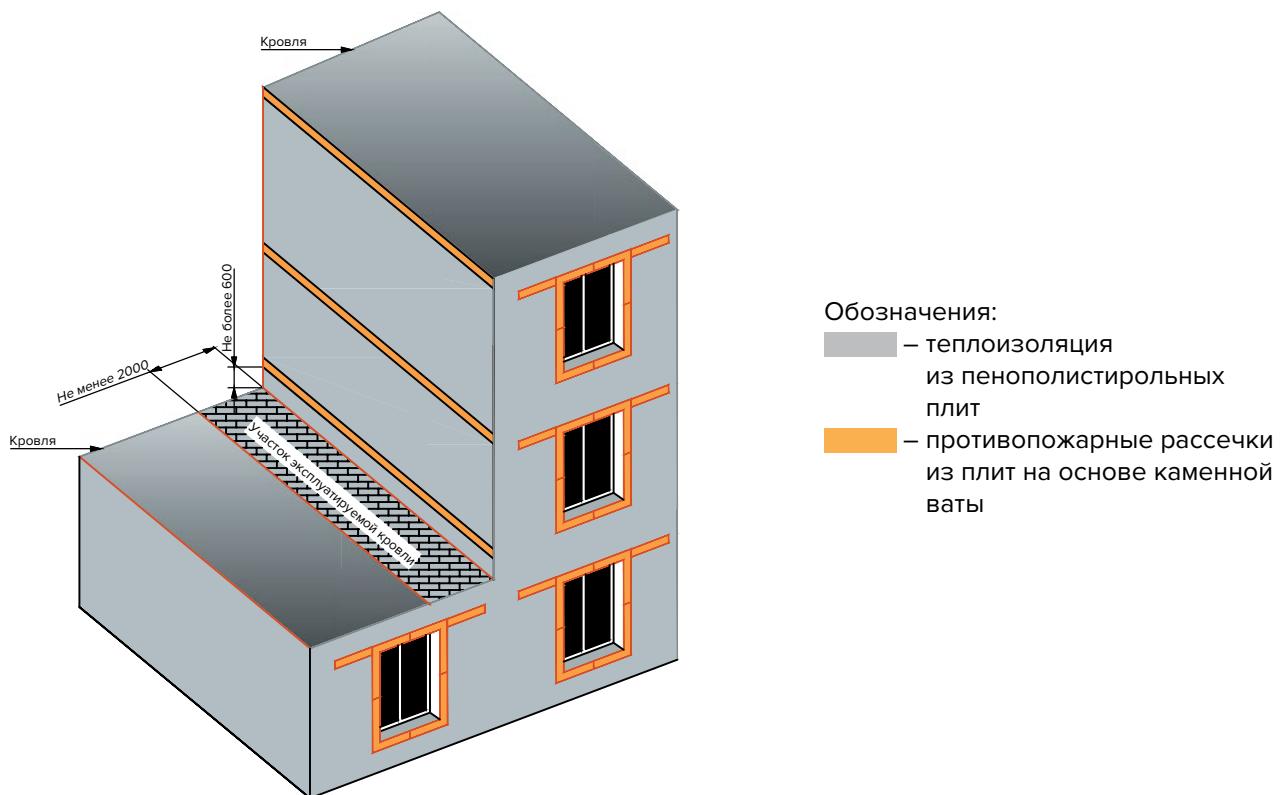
Примыкание СФТК к участку эксплуатируемой кровли
